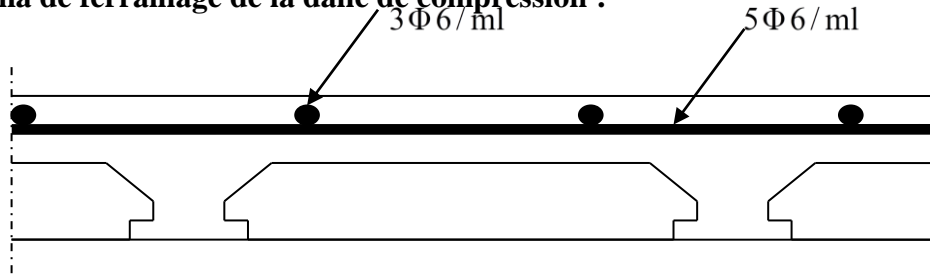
Schéma de ferrailage de la dalle de compression.
